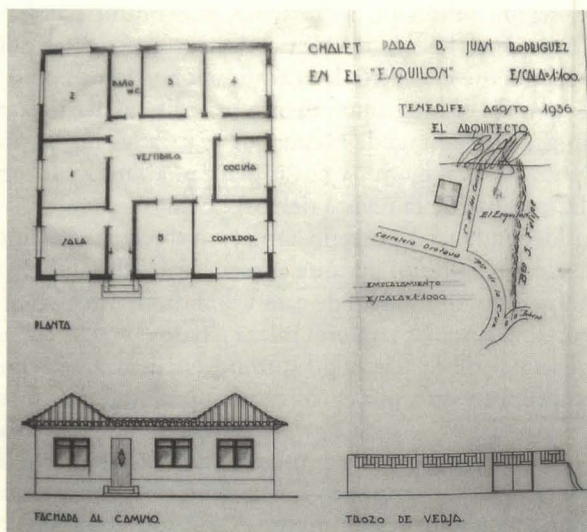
Chalet para D. Juan Rodríguez en el «Esquilón». Planta, alzado y diseño de verja, 1936.
